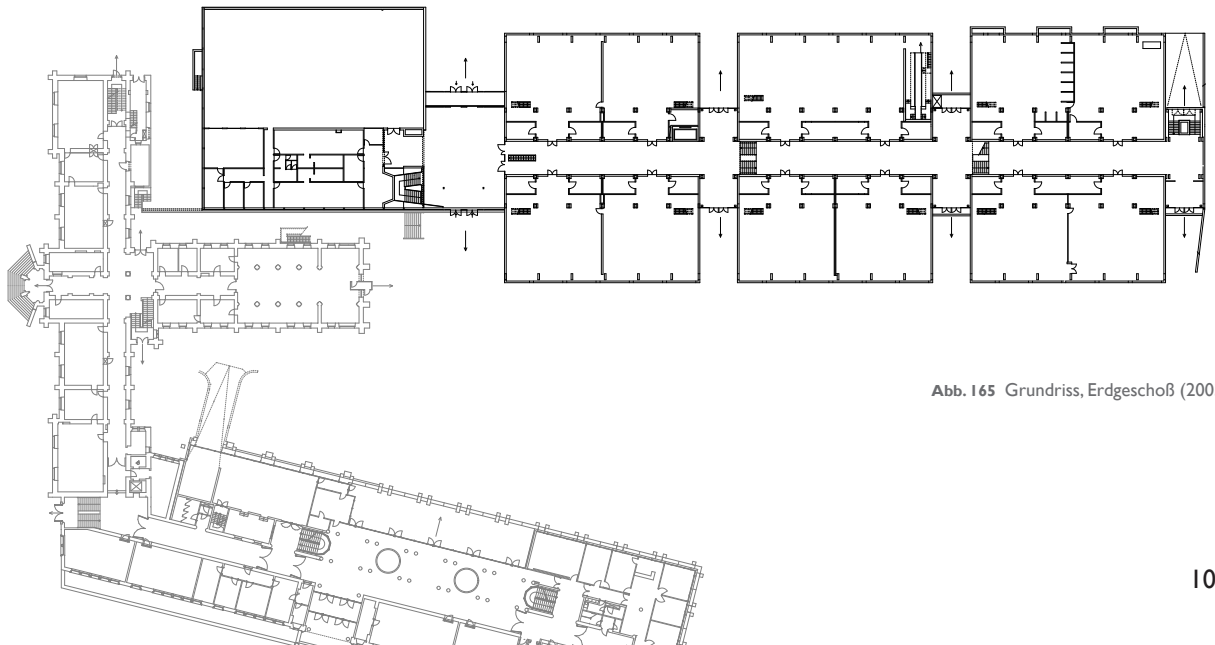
Grundriss, Erdgeschoß (2003)
